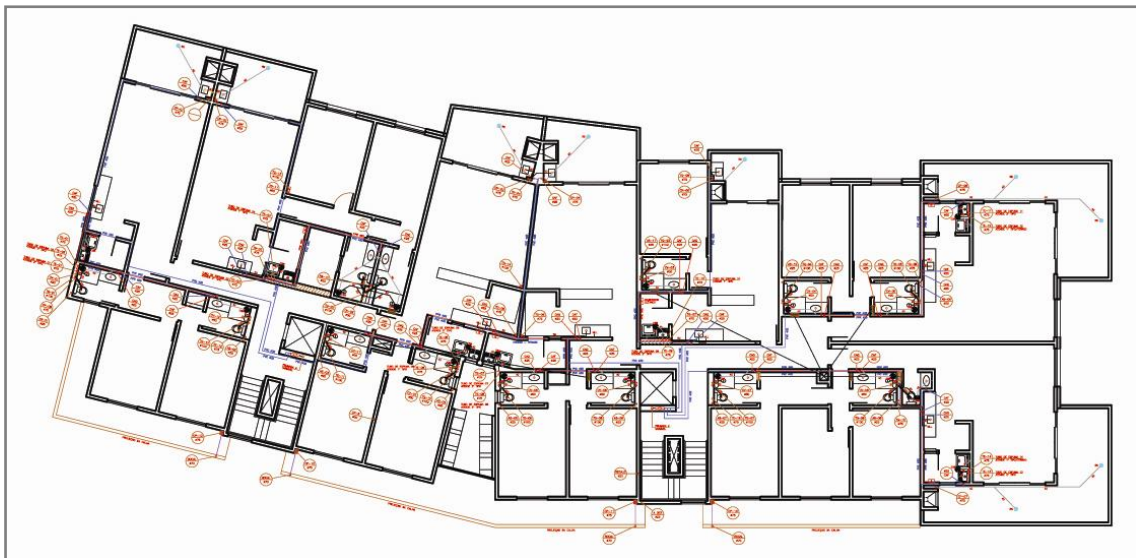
Planta baixa do projeto hidro-sanitário do pavimento tipo do bloco 03.
